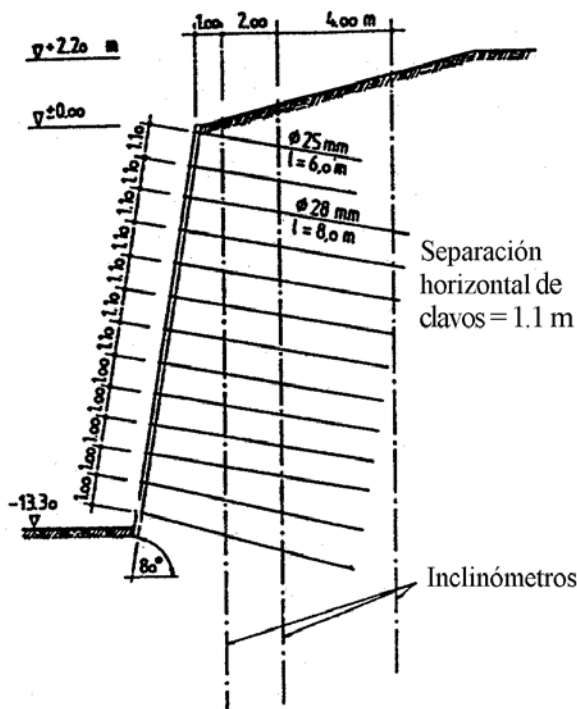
Sección transversal del muro instrumentado (Stocker & Riedinger, 1990).
